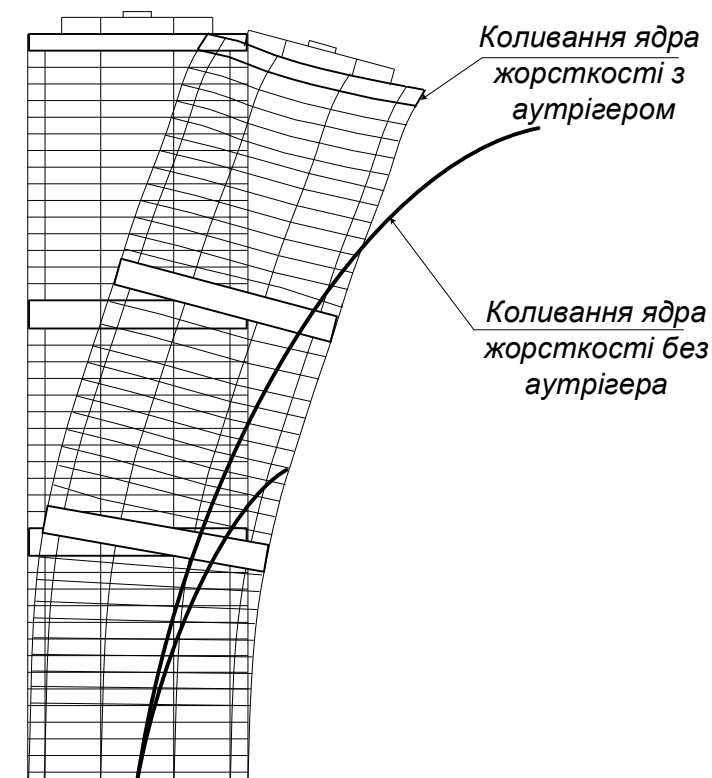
Порівняльна схема загальної жорсткості будівлі з аутрігерним поверхом та без нього
